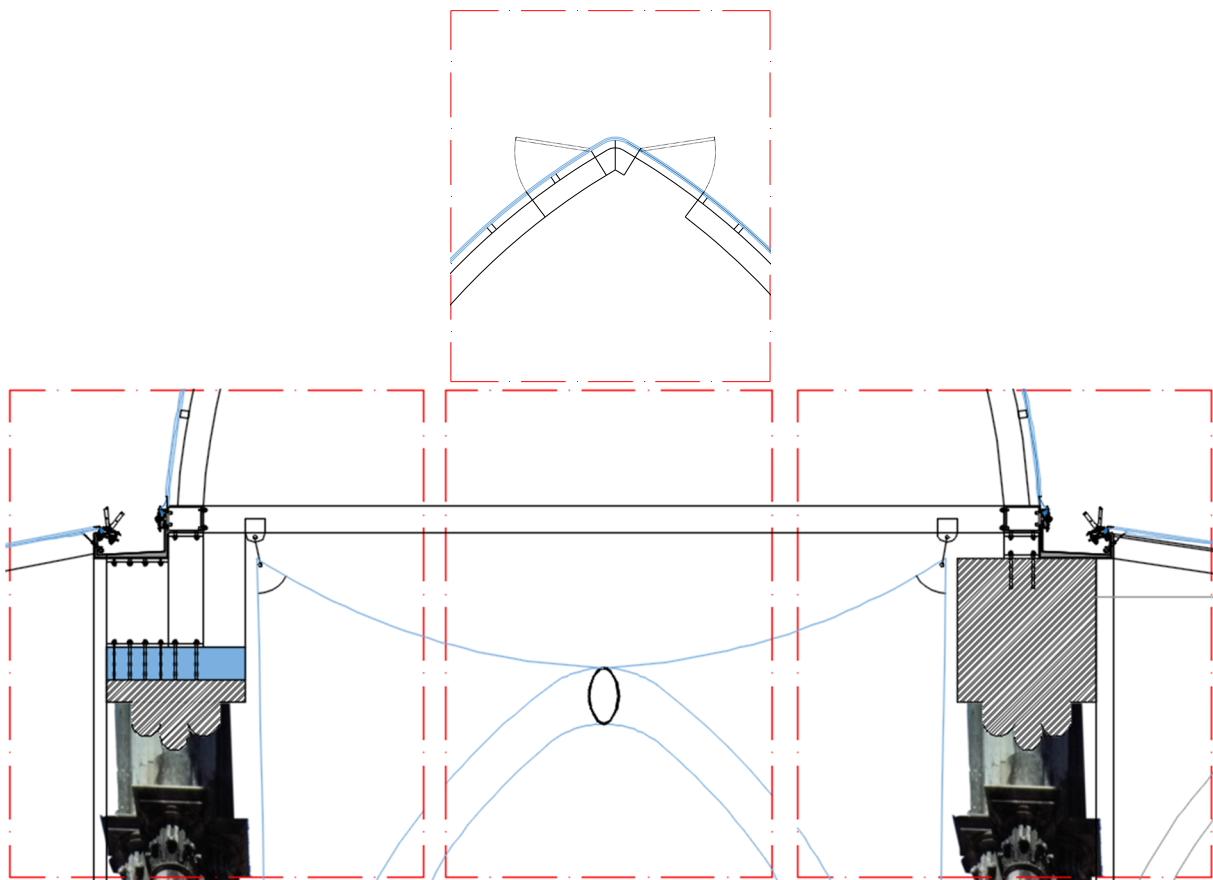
Pormenor da ligação da cobertura proposta aos elementos existentes.
